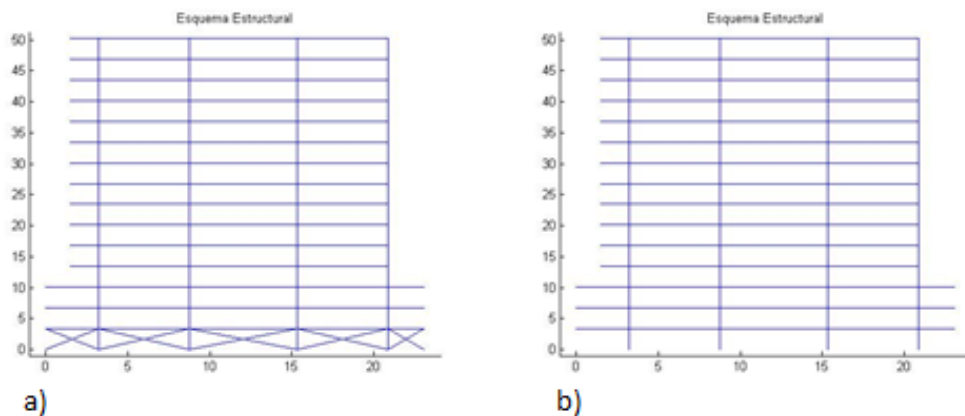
Pórticos longitudinales sin reforzamiento a) Pórtico A; b) Pórtico C.
